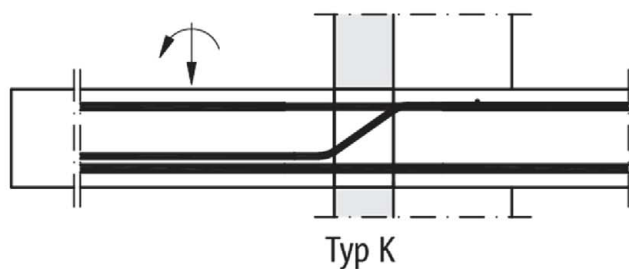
Schöck Isokorb® Typ K, K-F (Variante mehrteilig) für frei auskragende Balkone mit Stahldruckstäben
